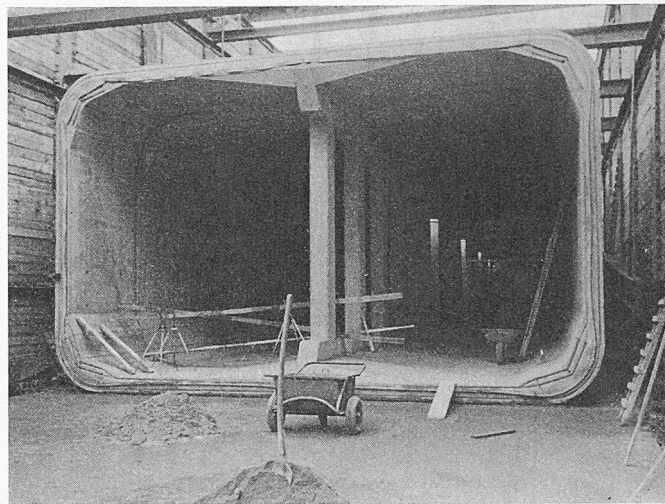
Zweigleisiges Tunnelfertigteil in Spannbeton
